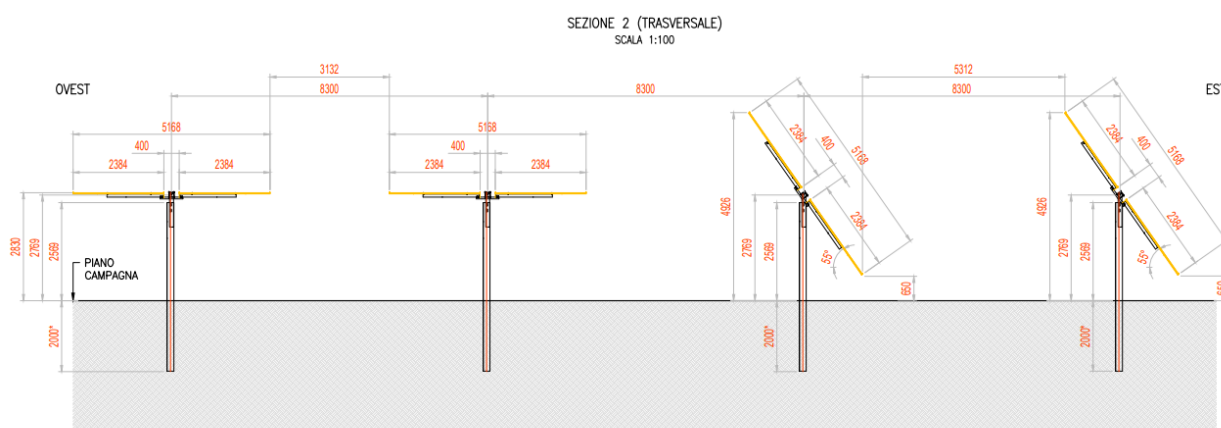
Particolare strutture di sostegno moduli, sezione trasversale.
